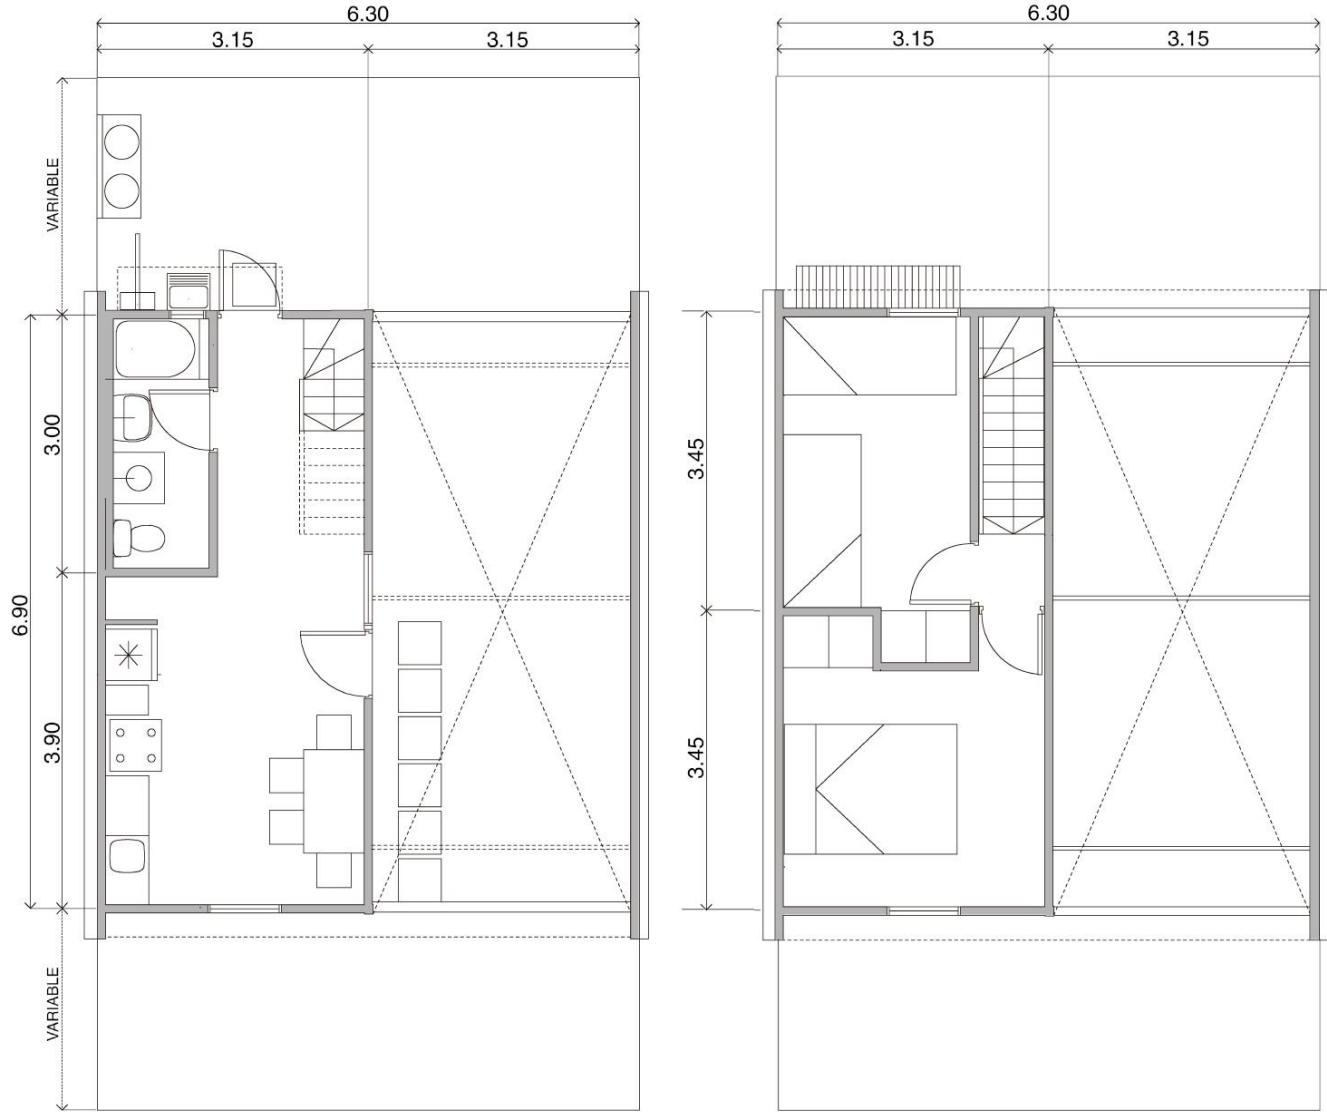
Planta baja y primer nivel sin ampliación. Nota:
